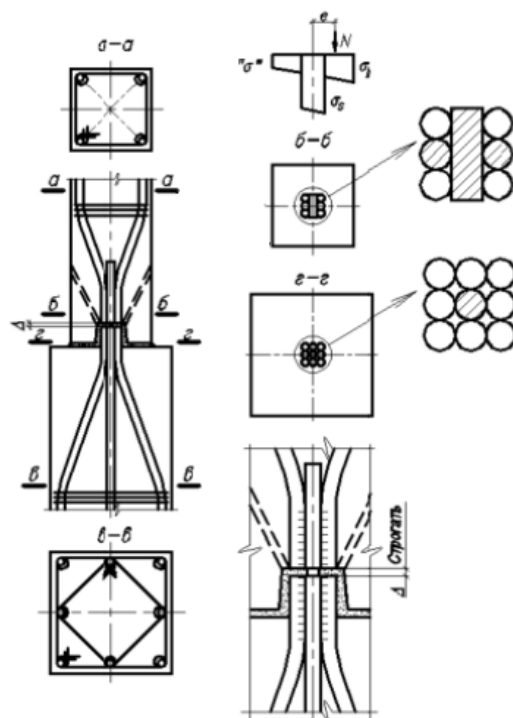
Схема плоского бессварочного стыка и допуски на изготовление и монтаж
